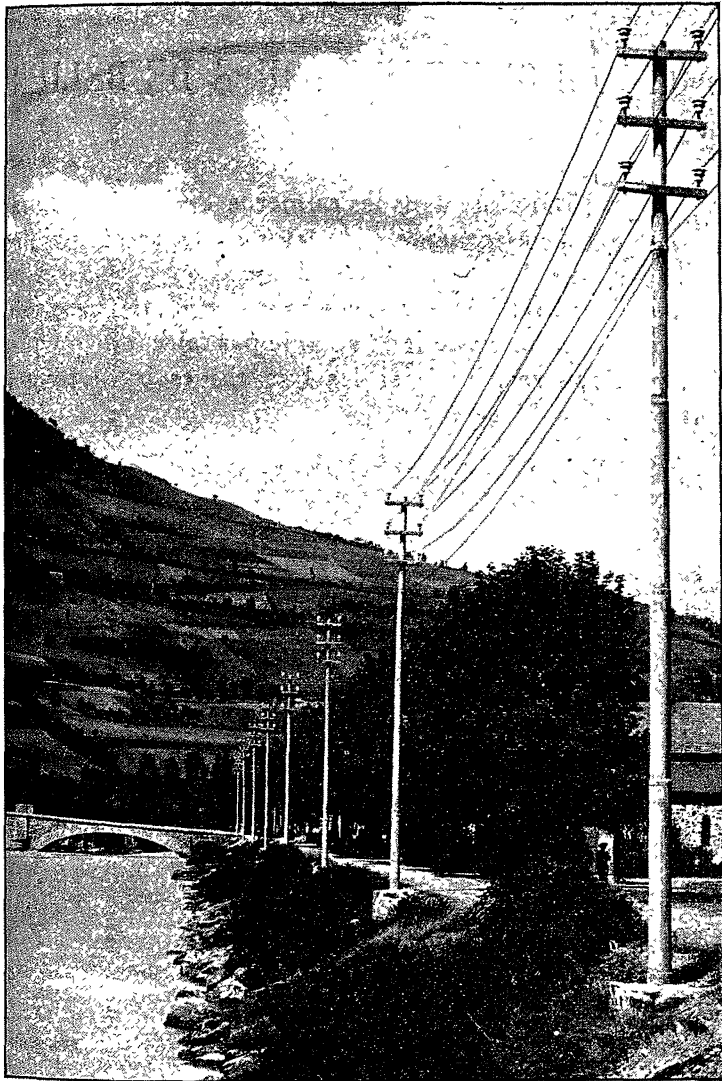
Poteaux en ciment armé de la ligne Livet-Grenoble. Vue prise au Péage de Vizille.
